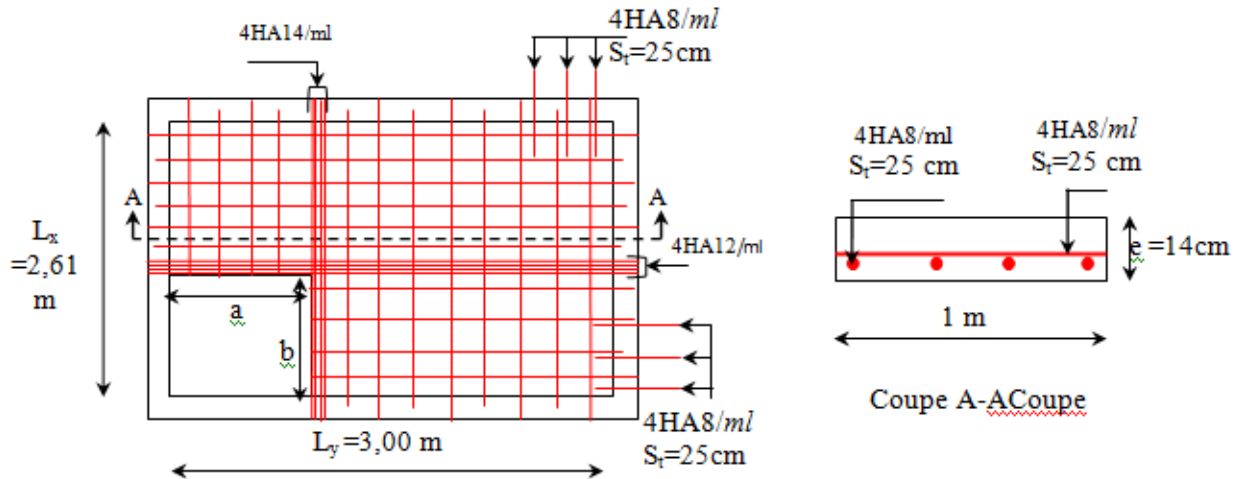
Schéma de ferrailage de la dalle D<sub>ASC</sub>
